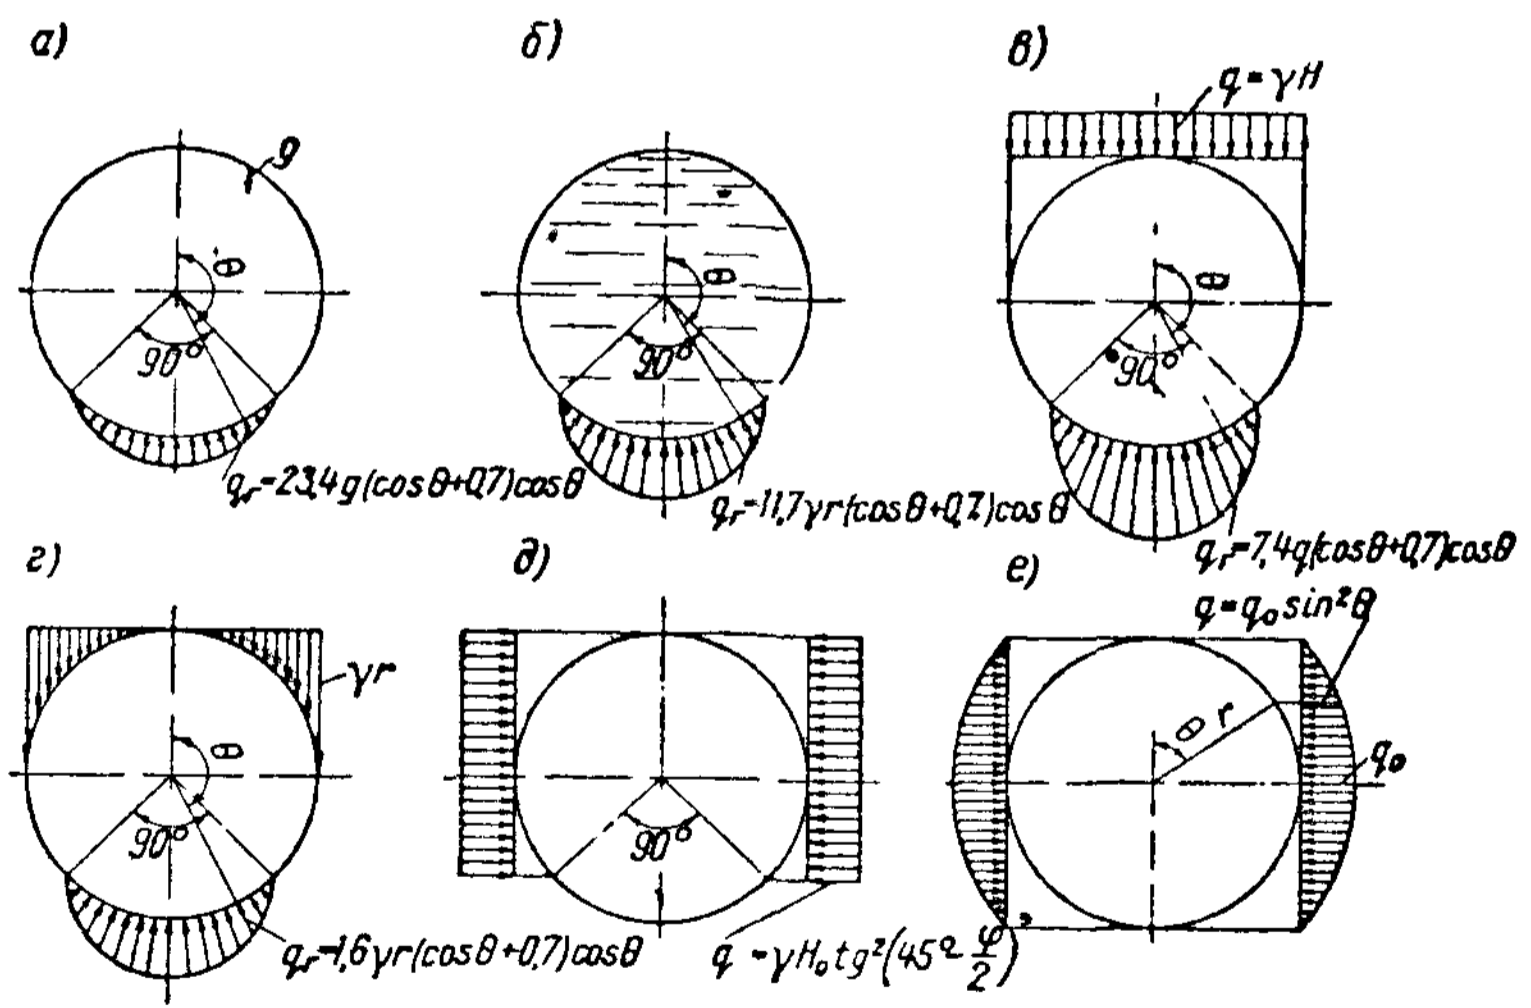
Поперечные нагрузки, действующие на подземный трубопровод, опирающийся на профилированное грунтовое ложе с углом охвата $2\alpha = 90^\circ$
